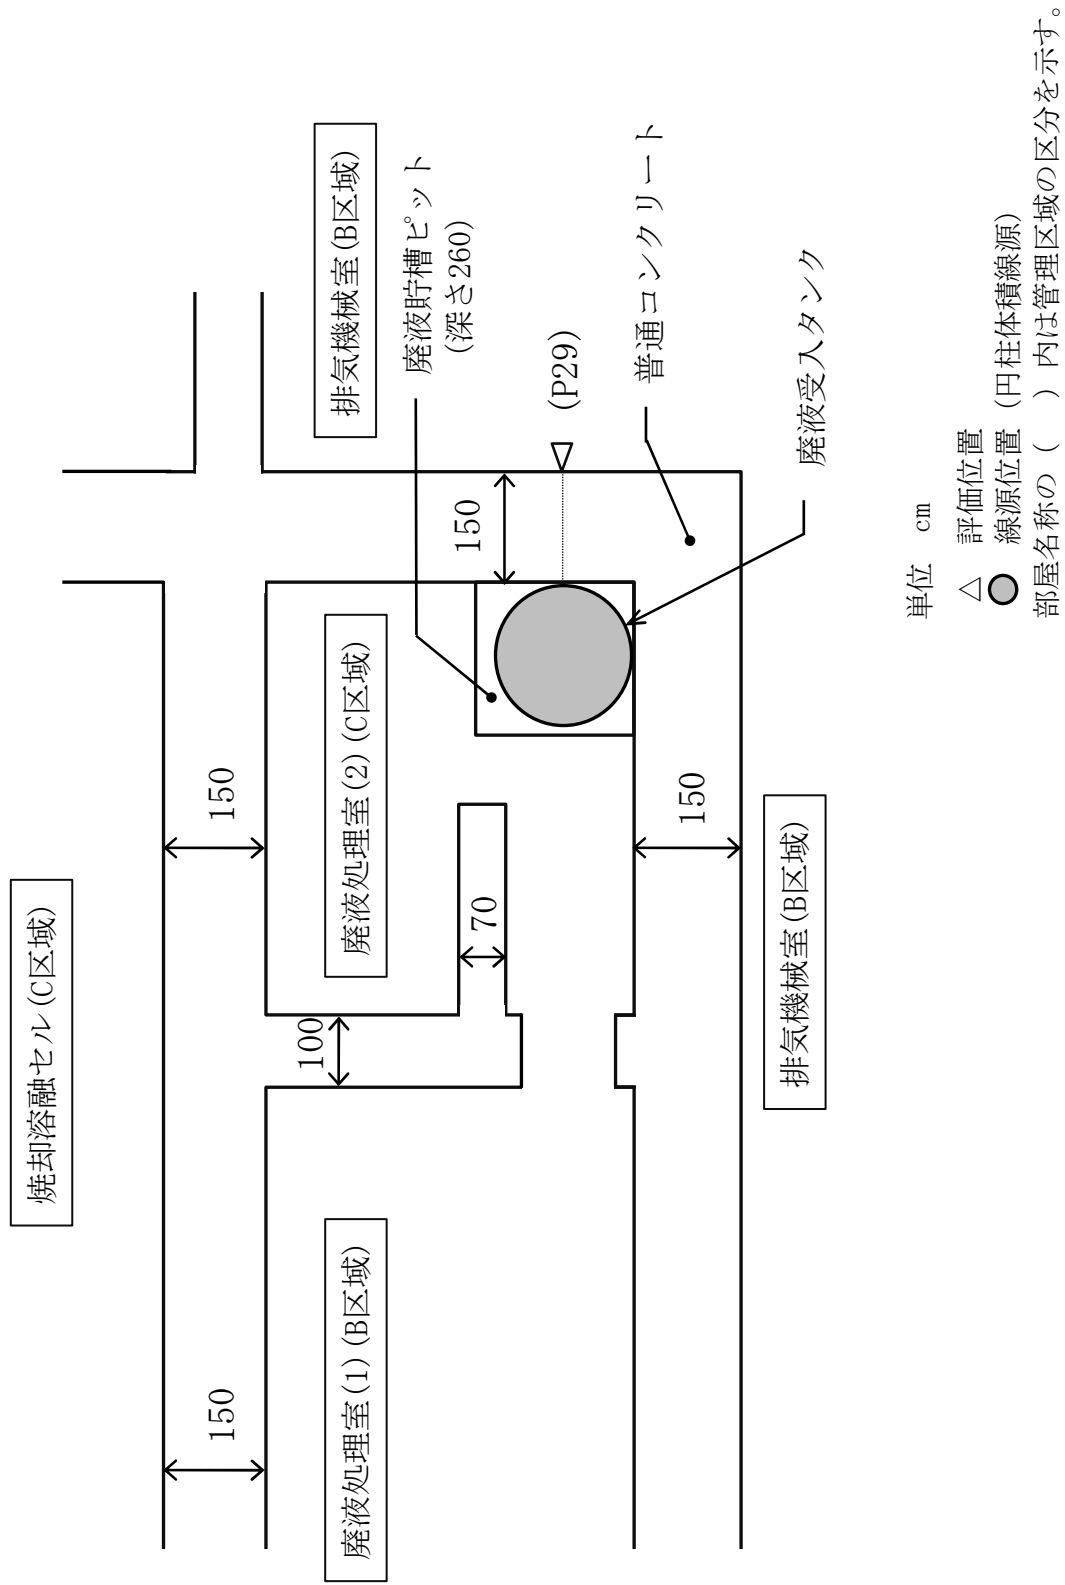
(17) 廃液処理室(2)の線量率評価位置図(平面図)
